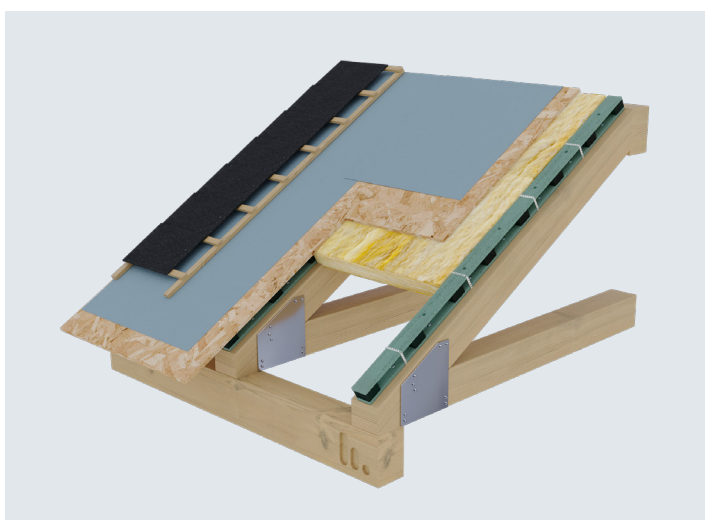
Stravifloor Batten sobre estructura de madera (tejado).
